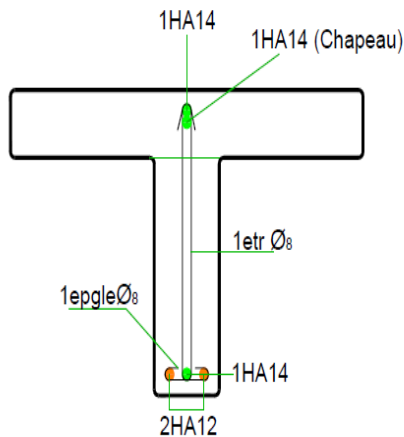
Schéma de ferrailage du type 13 appuis intermédiaire
